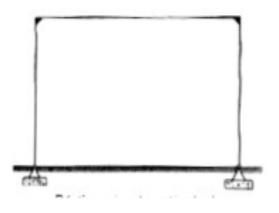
Pórtico. (Fuente: Sistemas Estructurales 10)
